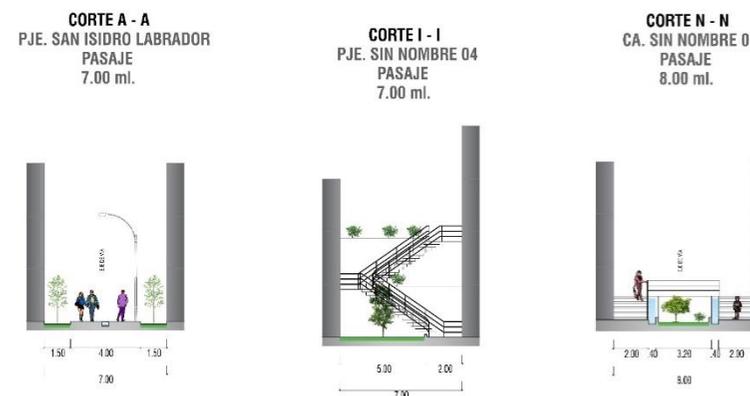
Secciones tipo de vías locales de la ZRESS10-15
